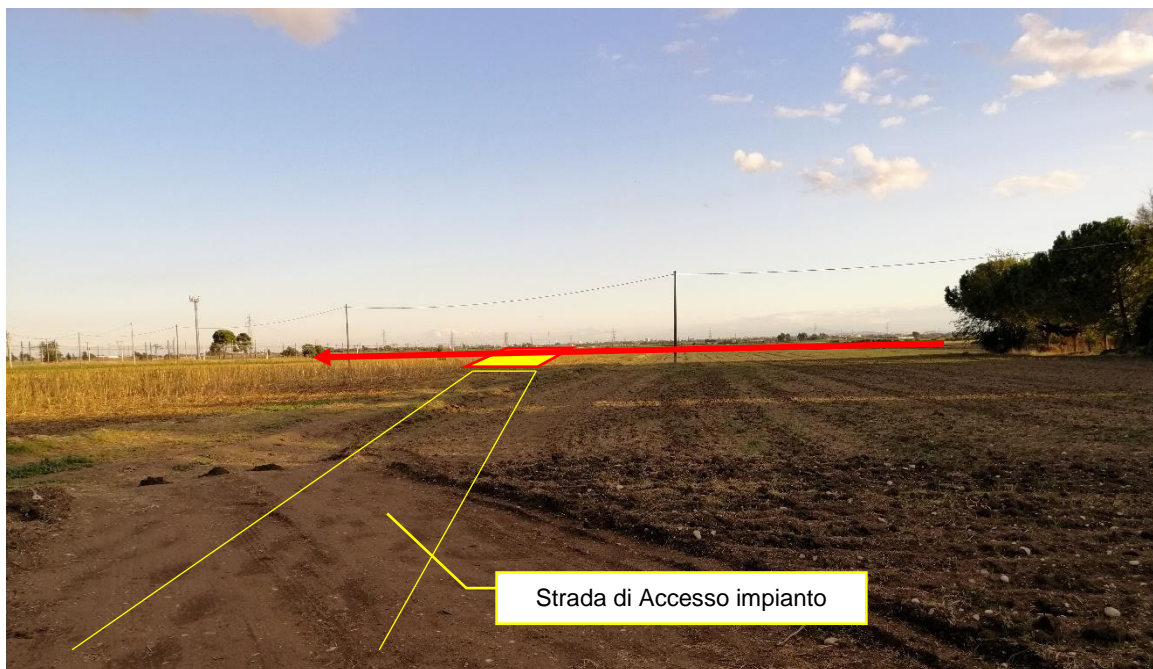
Panoramica senso-gas all'impianto PIL n.5 a monte dell'attraversamento ferroviario (Ferrovia Adriatica) dalla strada di accesso
